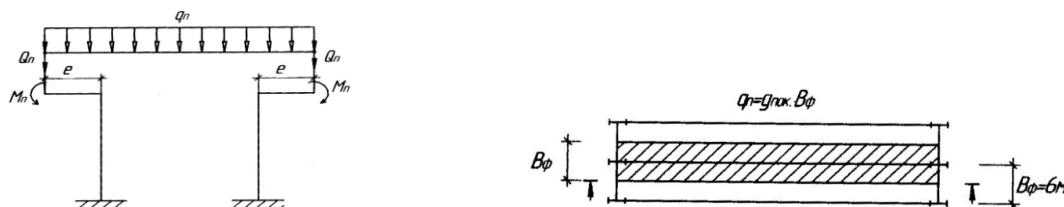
Схема для определения нагрузки от конструкций покрытия
